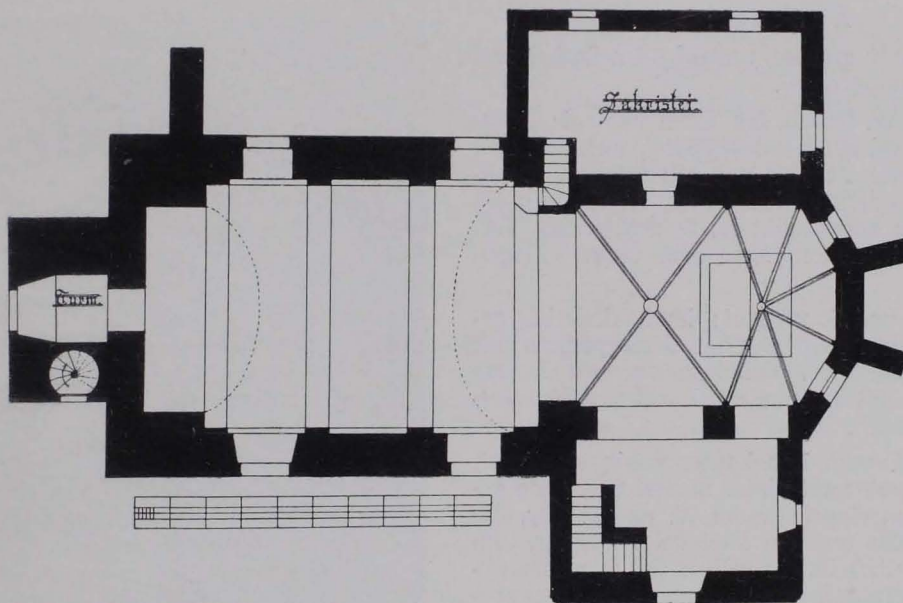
Münichreith, Pfarrkirche, Grundriß 1 : 200 (S. 36)
